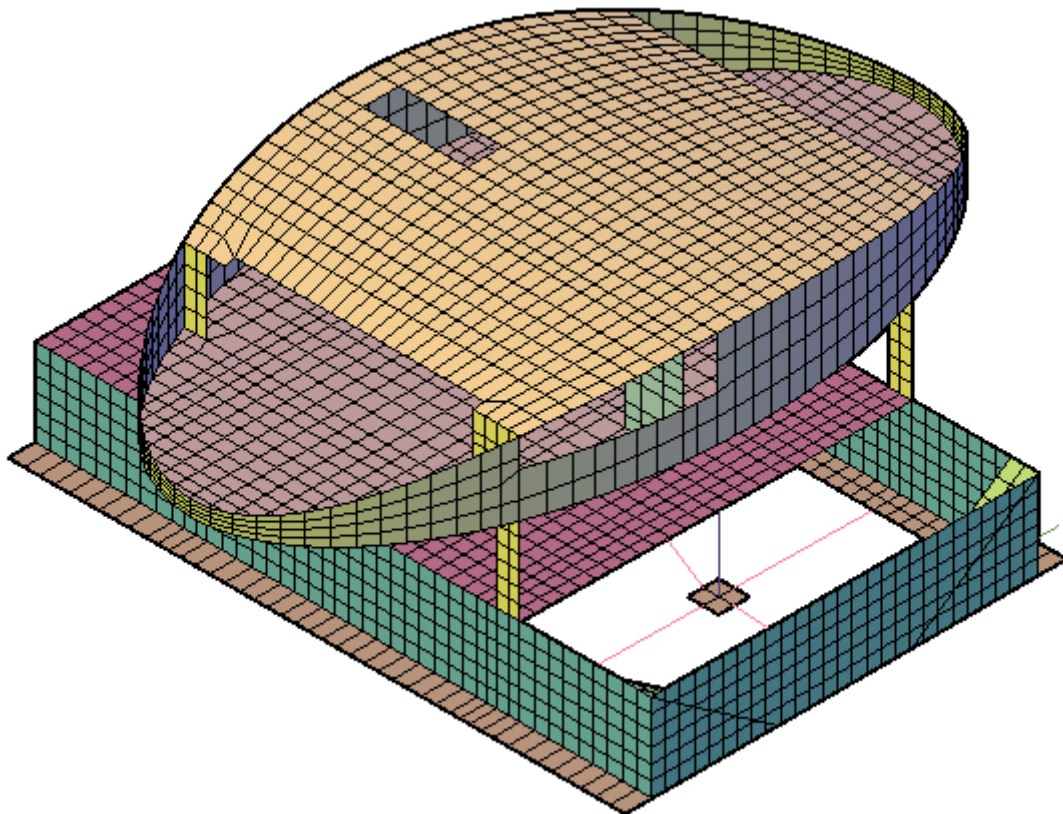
1. Geometría del modelo de cálculo. Fuente: elaboración propia.
